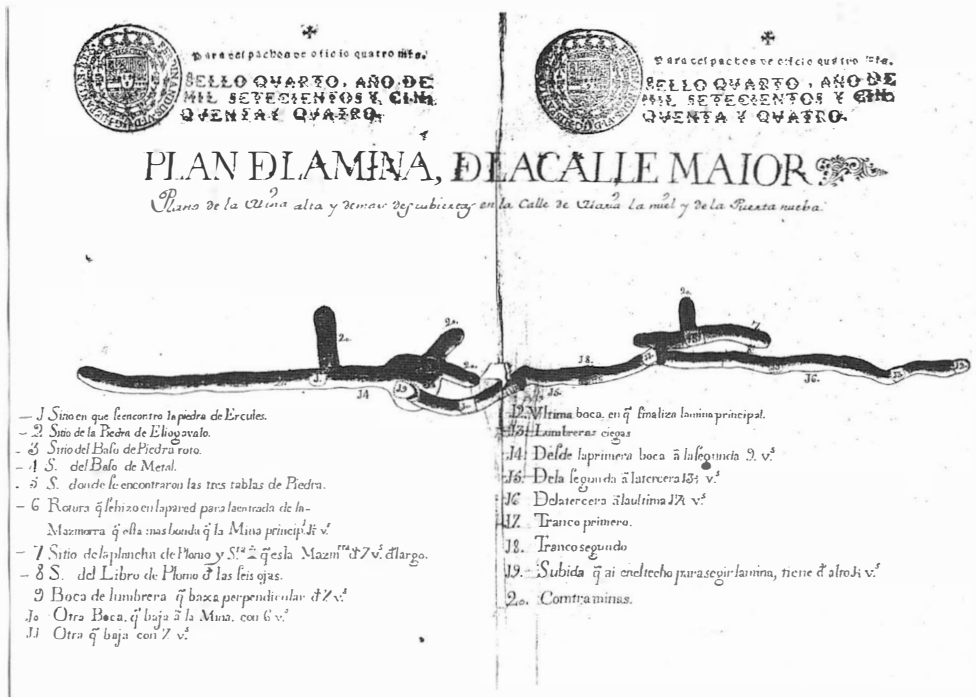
Planta de las «minas» (1754) (Redescubierta y ofrecida por D. Martín Almagro Gorbea).
